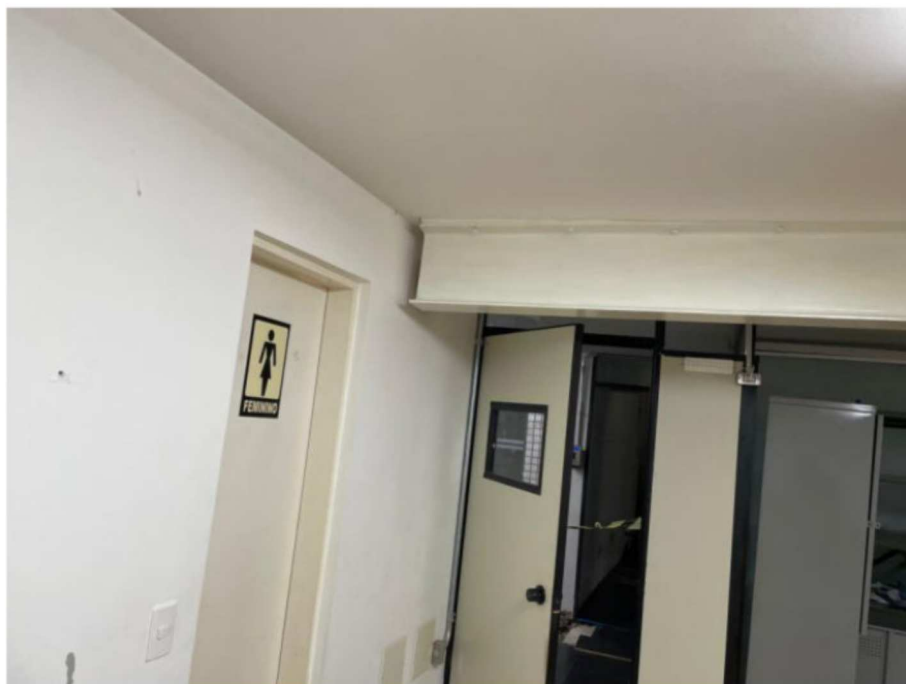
Reforço em viga metálica da laje do primeiro pavimento.
